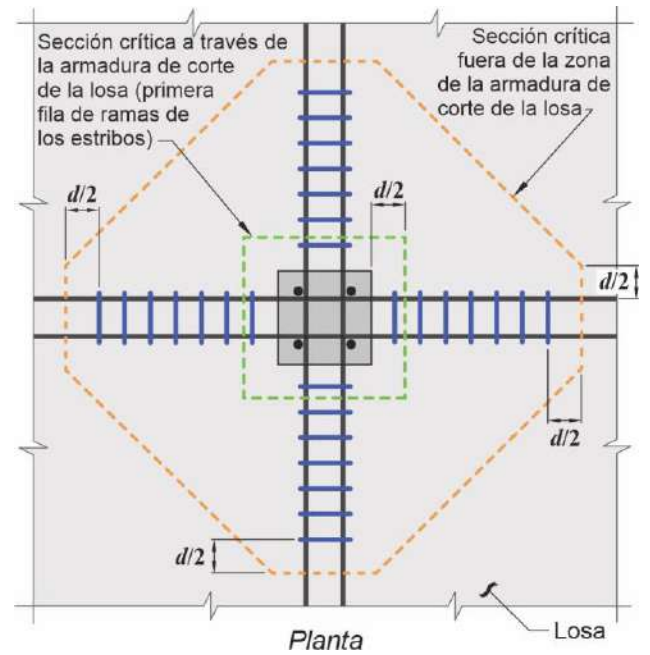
Secciones críticas para corte en dos direcciones en losas con armadura de corte en columnas interiores
